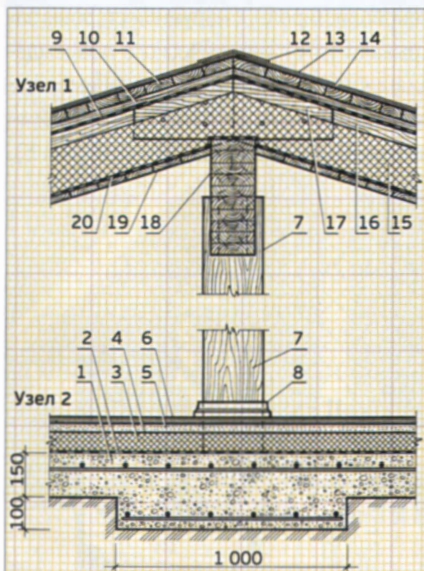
Узлы 1 и 2 (см. рис. 2): 1 — монолитная железобетонная стена; 2, 9 — гидроизоляция; 3, 15 — теплоизоляция; 4 — полиэтиленовая плёнка; 5 — стяжка; 6 — паркетная доска; 7 — клеёная деревянная стойка; 8 — плинтус; 10 — контробрешётка; 11 — деревянный настил; 12 — коньковый элемент; 13 — подкладочный слой; 14 — мягкая кровля; 16 — стропило; 17 — накладка; 18 — клеёная деревянная балка; 19 — чистовая подшивка потолка; 20 — пароизоляция.
